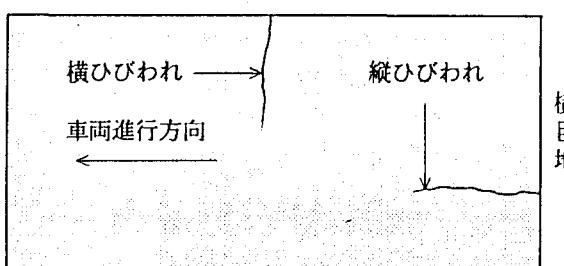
疲労解析の対象とするコンクリート版のひびわれ
